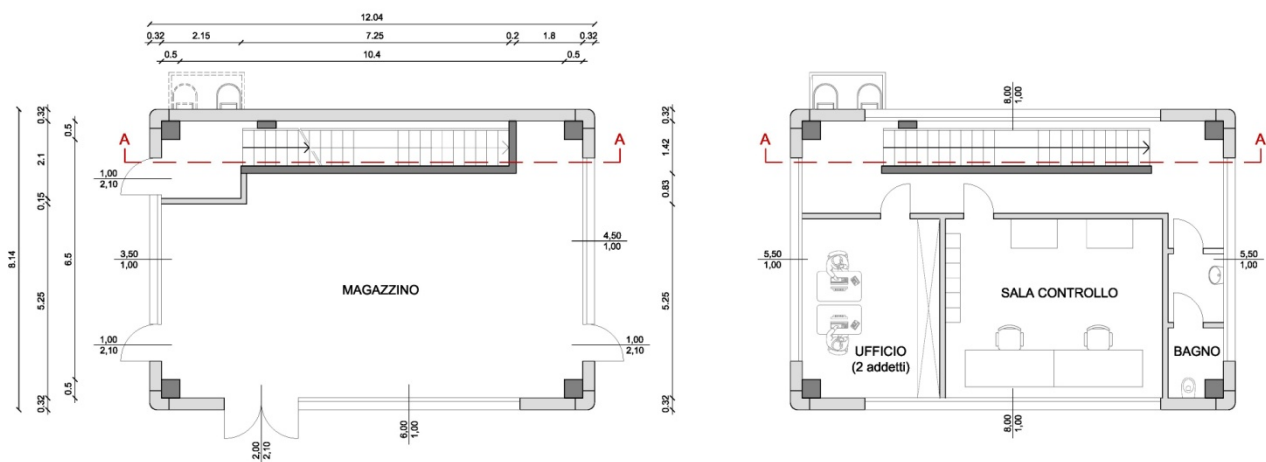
Pianta palazzina – a sinistra pianta piano terra, a destra pianta del piano primo
